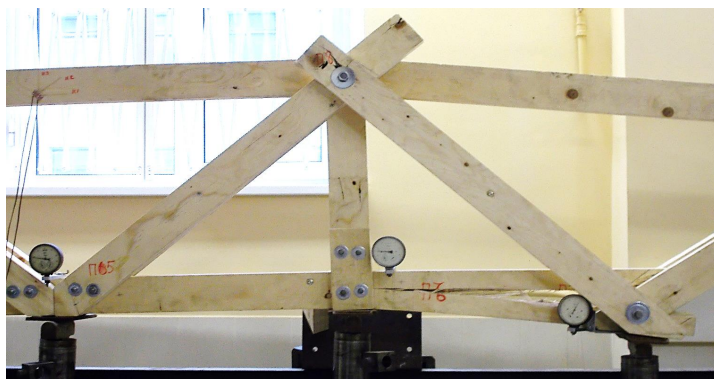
Разрушение конструкции фермы при испытаниях
